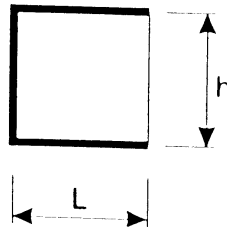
Maintien en tête et en pied et sur une rive verticale
